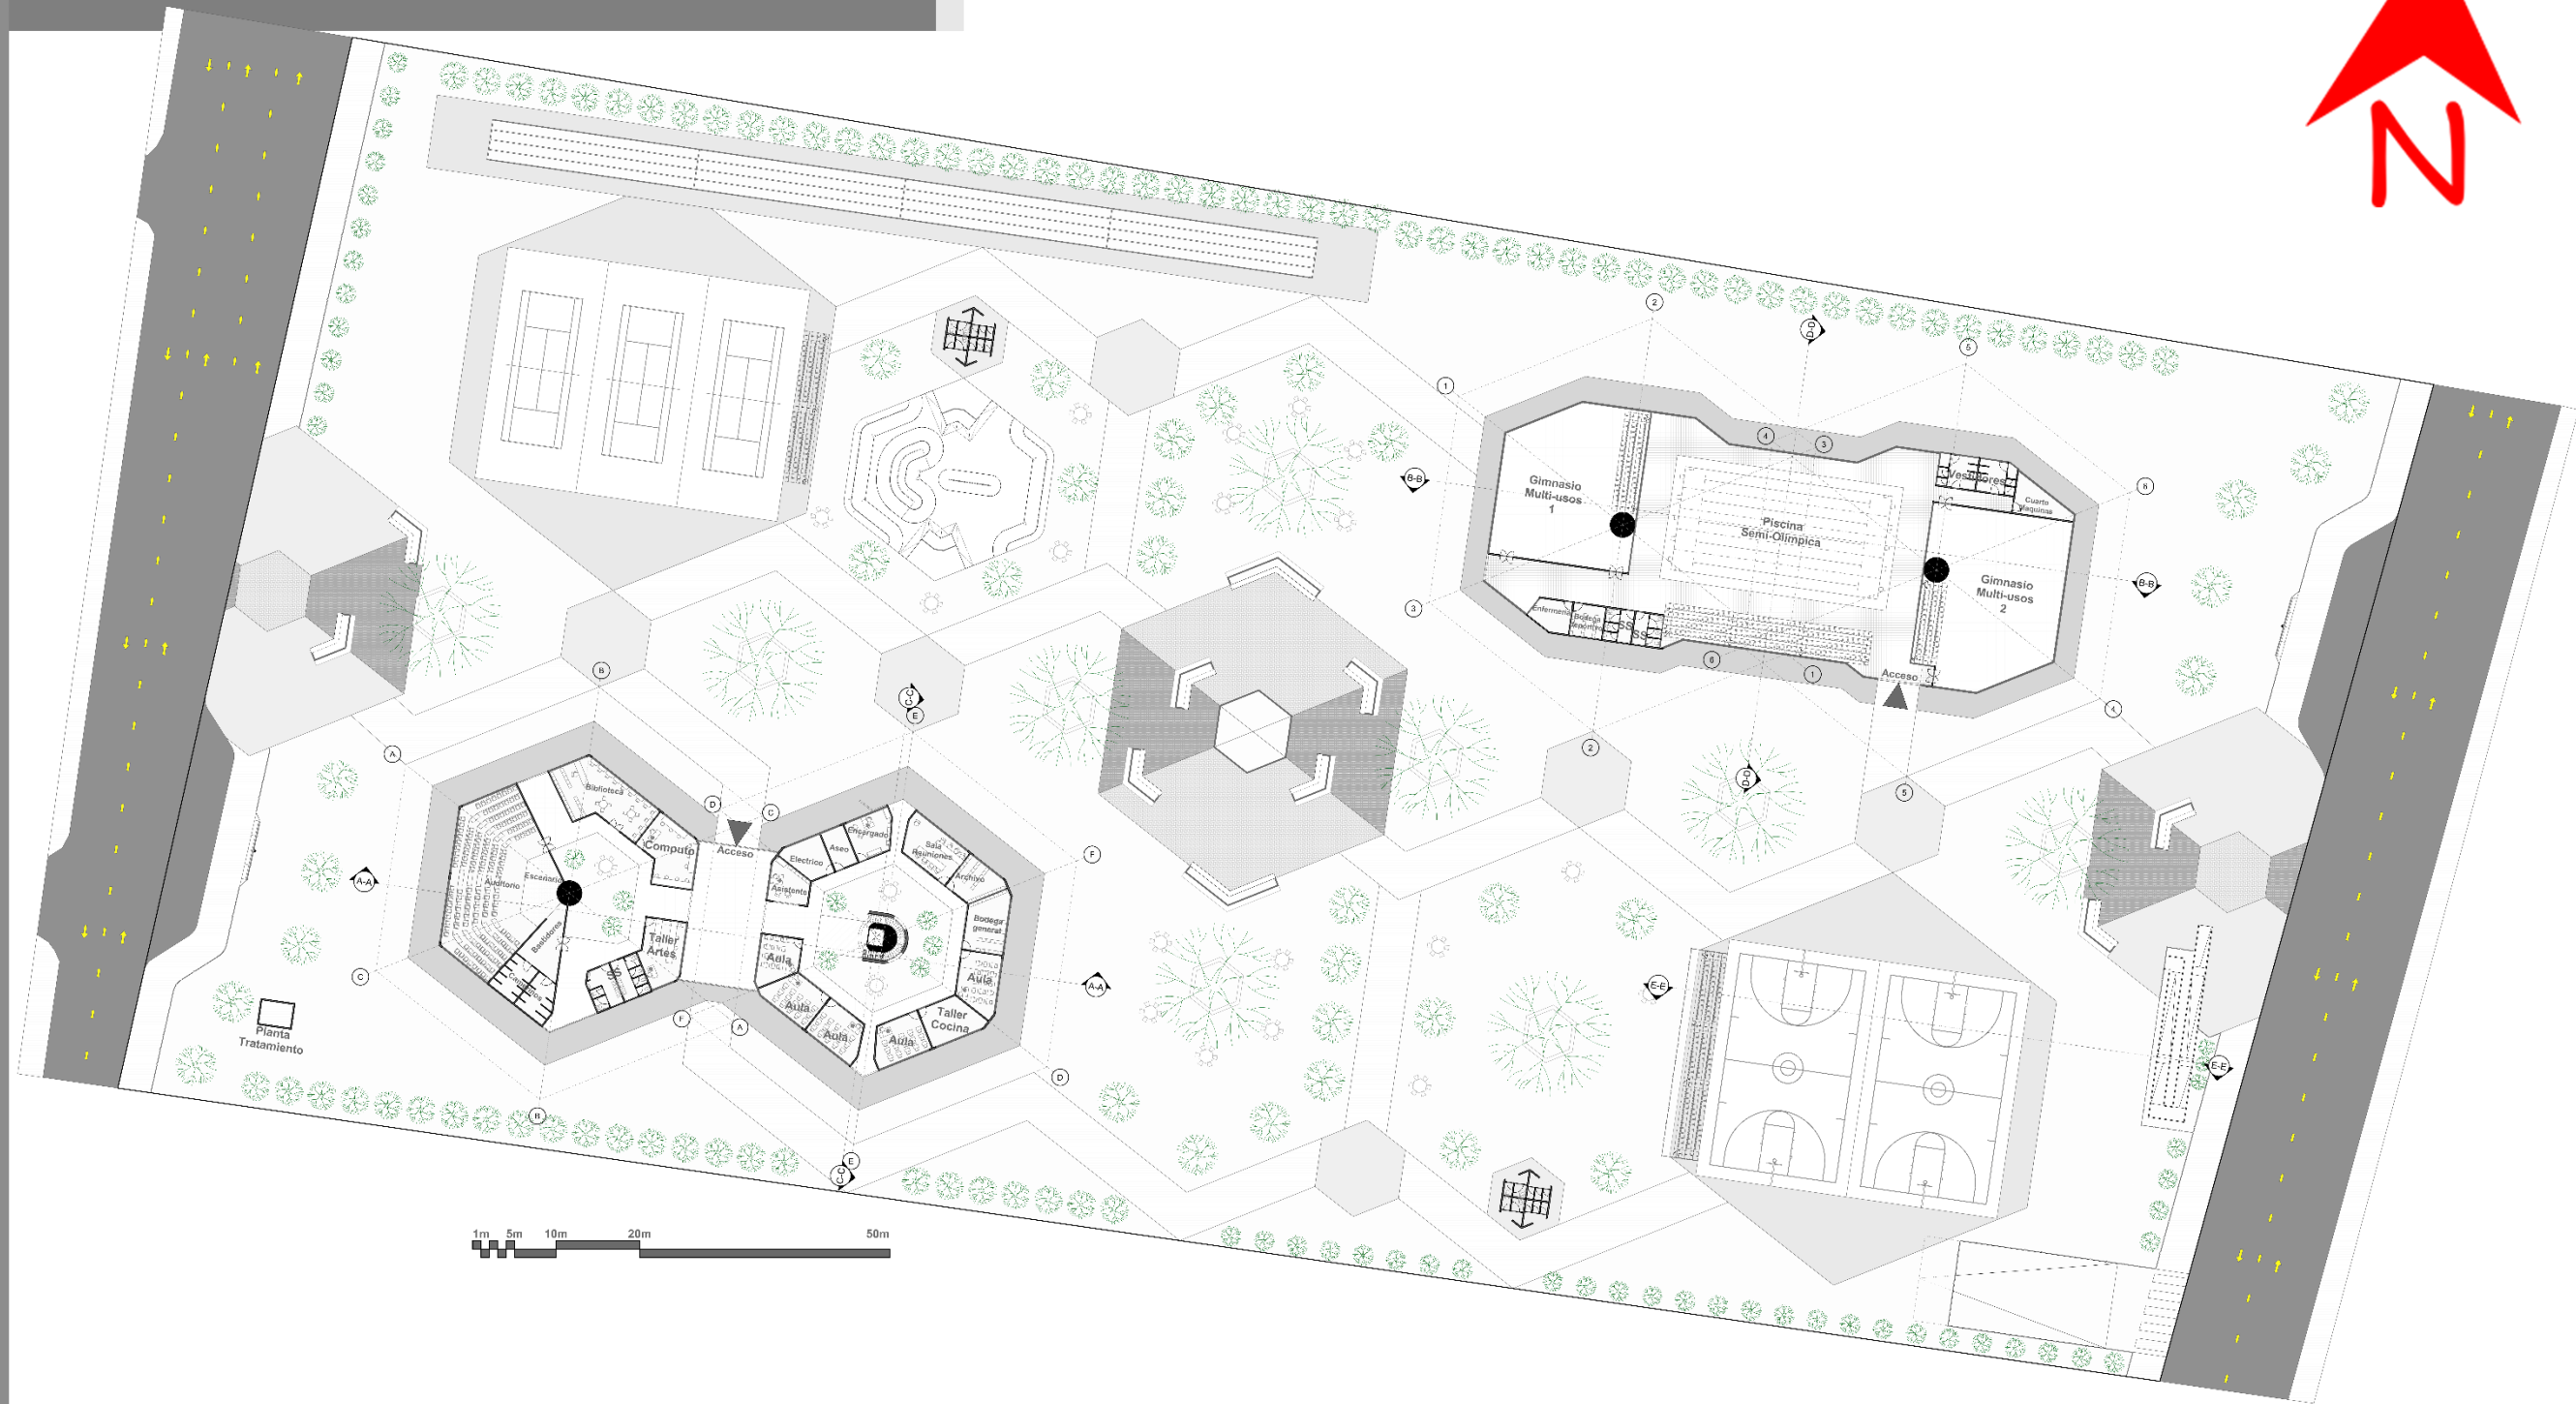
, Planta Arquitectónica General, Propiedad Personal, Tomado 2023
